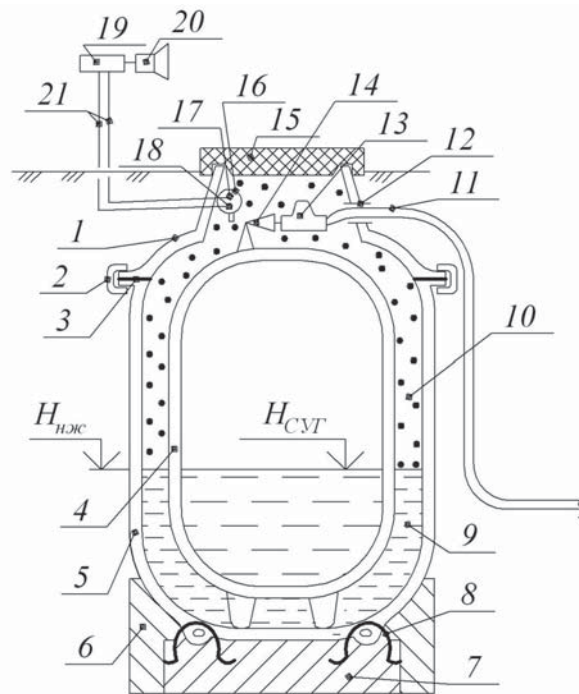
Конструкция системы защиты РПВ: 1 — верхняя часть полимерного футляра (ПФ); 2 — стягивающий хомут; 3 — герметизирующая прокладка; 4 — стальной сосуд СУГ; 5 — нижняя часть полимерного футляра; 6 — дополнительный балластирующий фундамент; 7 — основная балластирующая фундаментная плита; 8 — разъемное соединение плиты 7 и нижней части полимерного футляра 5; 9 — незамерзающая инертная жидкость; 10 — газообразный азот; 11 — подземный газопровод; 12 — герметизирующая втулка;
